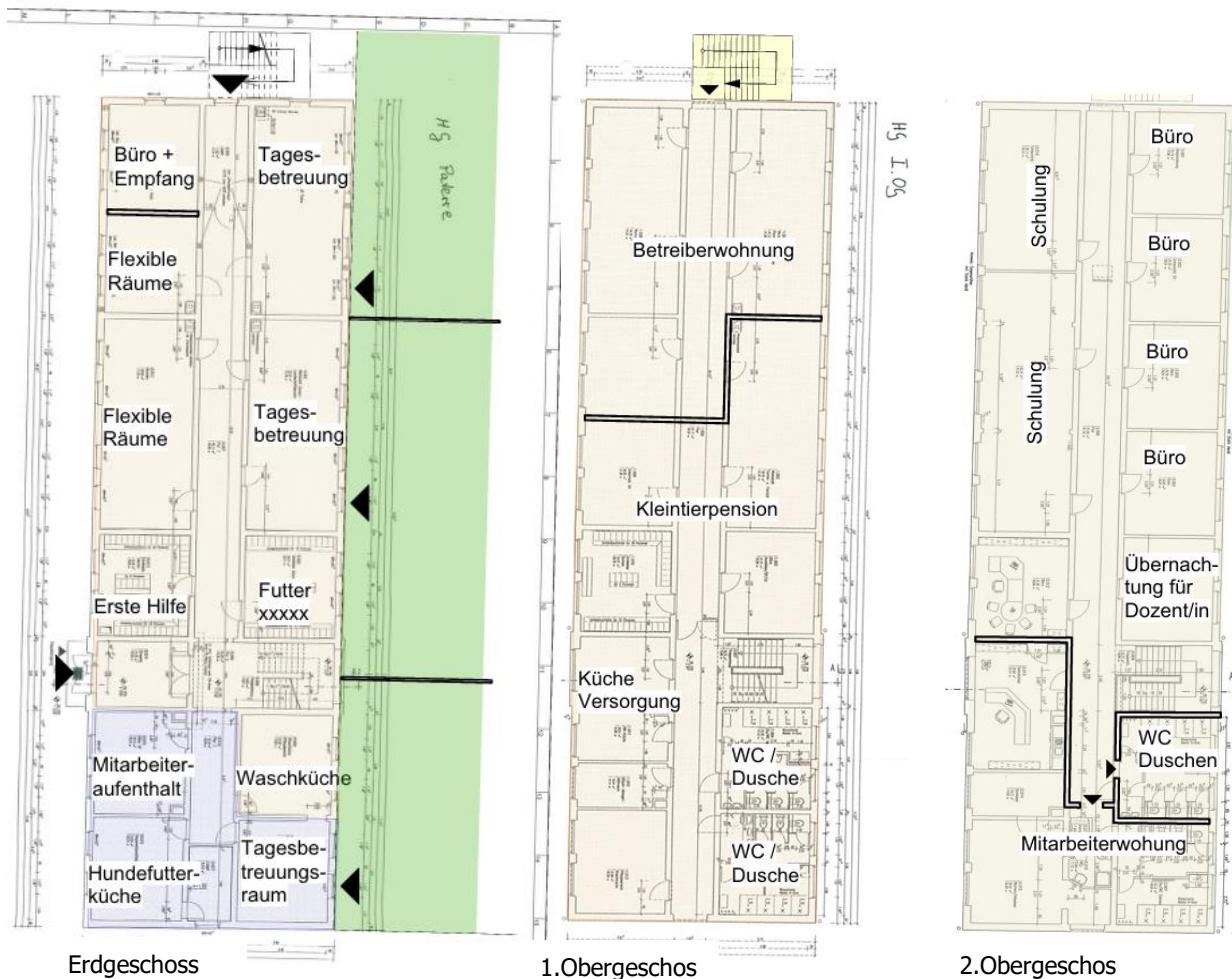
Grundrissorganisation im Hauptgebäude
